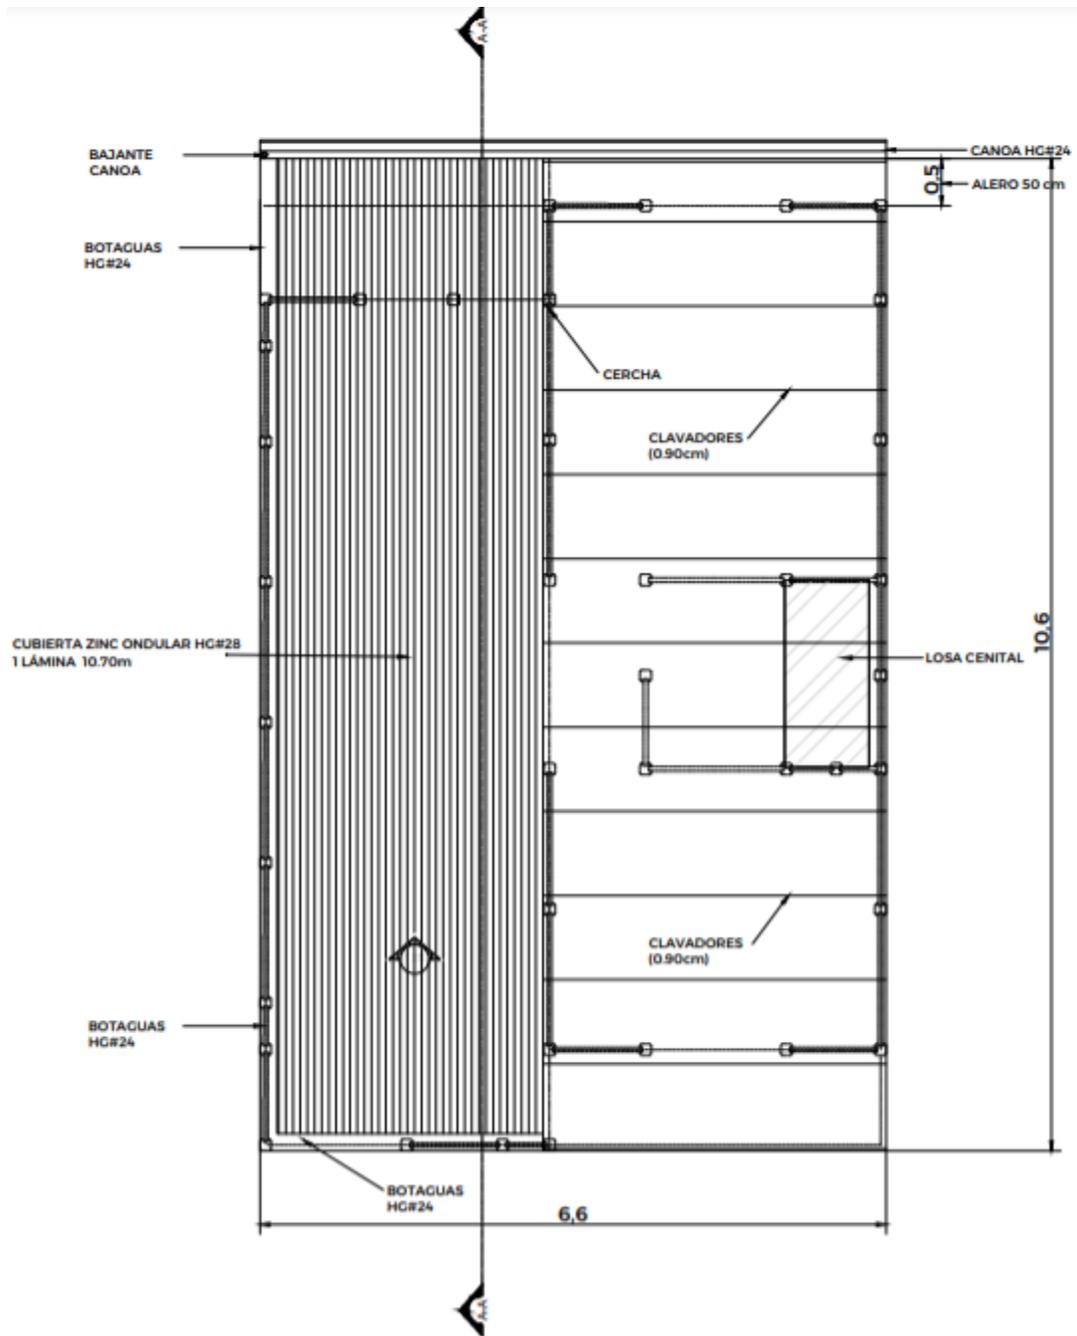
Detalle estructural de techos 1 agua Lamina Convencional - Sistema constructivo Prefabricado- lamina convencional
